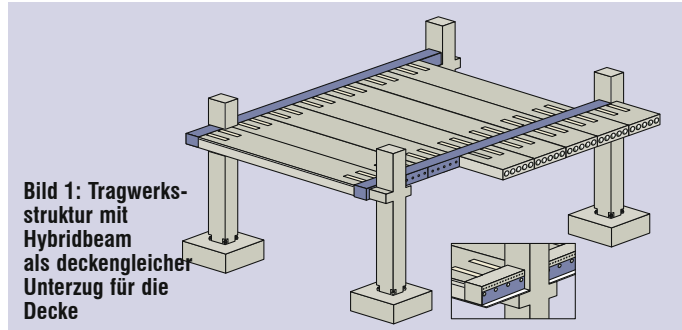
Tragwerksstruktur mit Hybridbeam als deckengleicher Unterzug für die Decke
